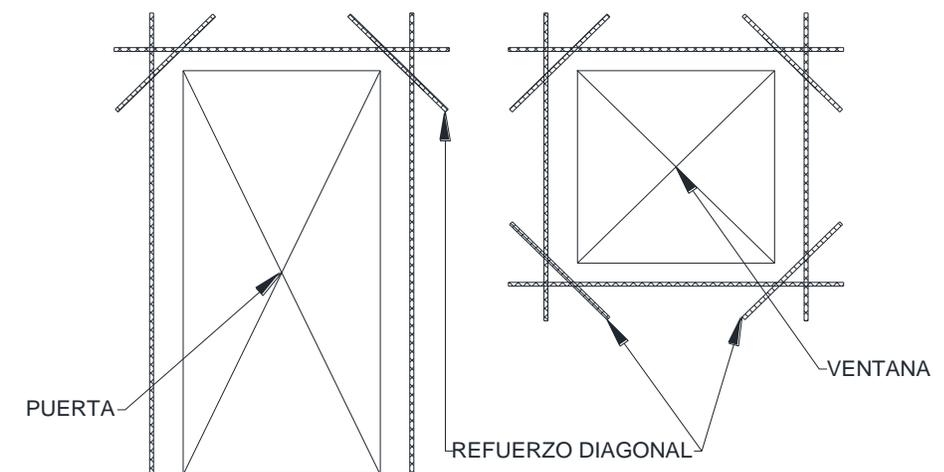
Esquema de refuerzo de vanos en paredes de concreto
